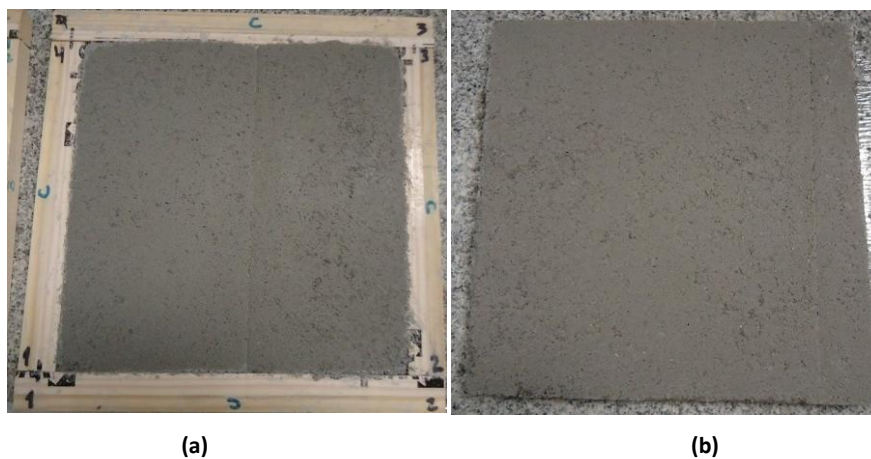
Aspeto final do fabrico das lajetas (a) com molde; (b) sem molde.
